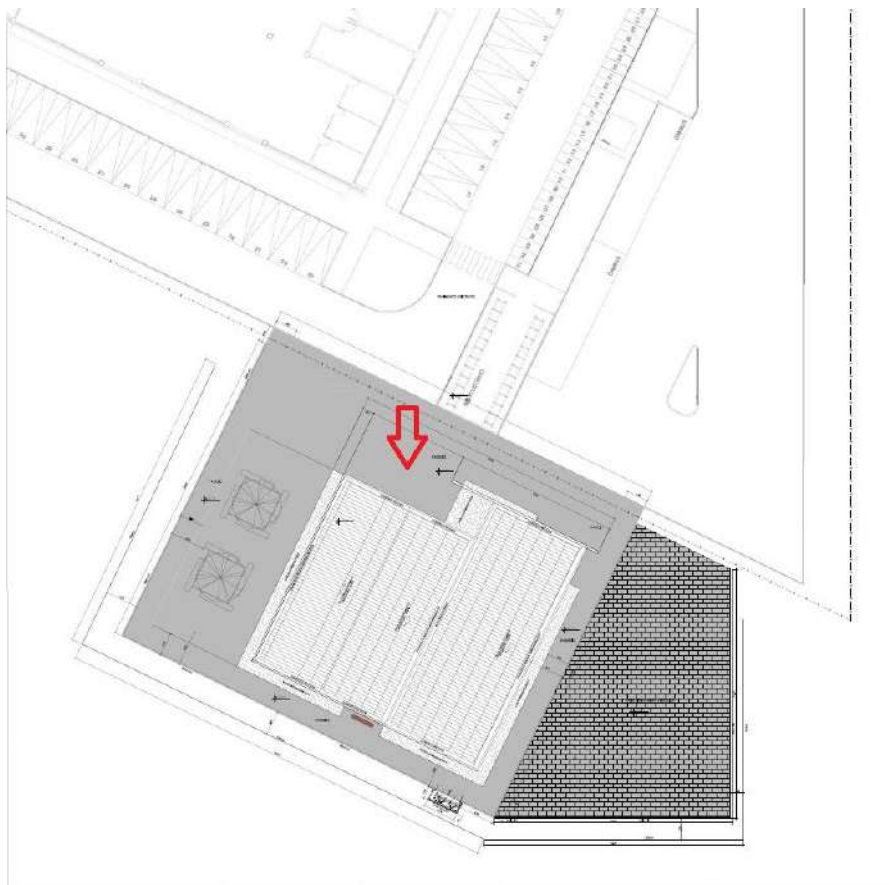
Locação do Restaurante no campus Poço Redondo.
